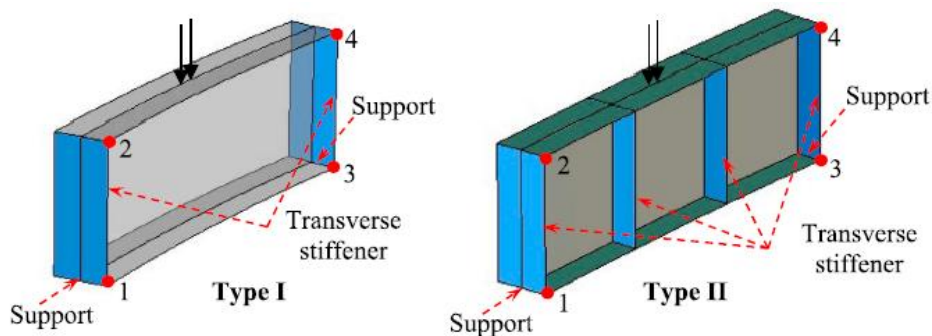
Protótipos de vigas de aço sujeitas a *patch loading*.
